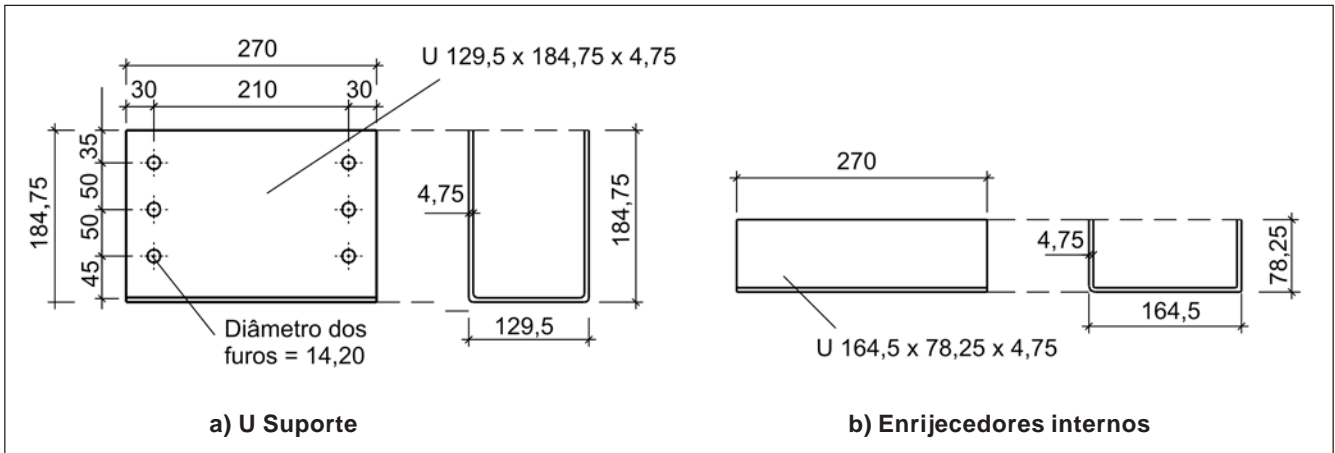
Detalhes das dimensões dos componentes da ligação proposta (dimensões em mm).
